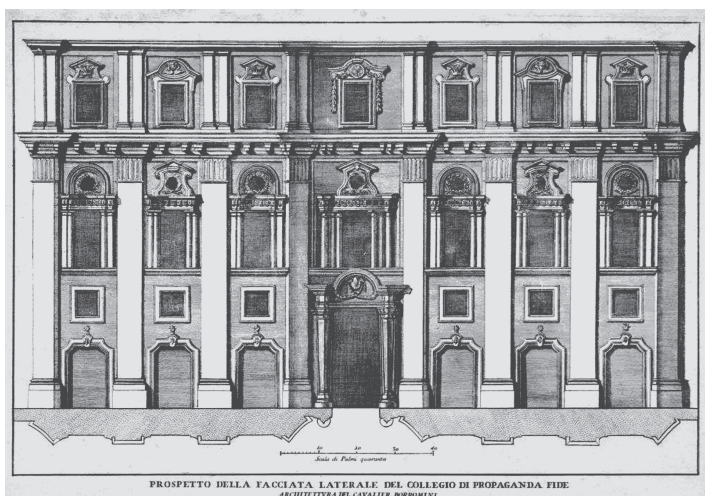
Francesco Borromini. Palais pour la propagation de la foi. Façade du corps central. Élévation et plan
